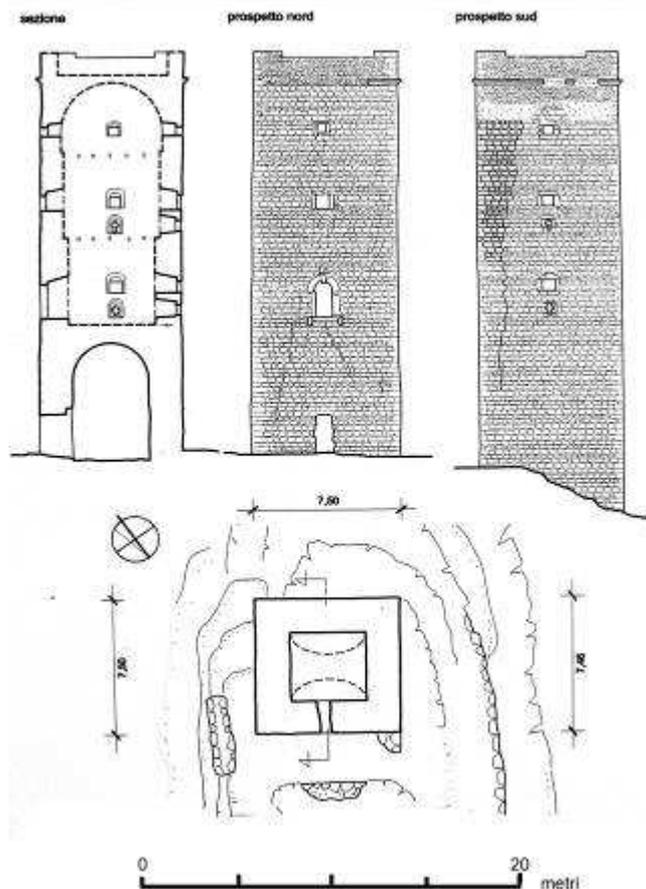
Castello di Torano. Pianta, sezione e prospetti del mastio (M. De Meo)
